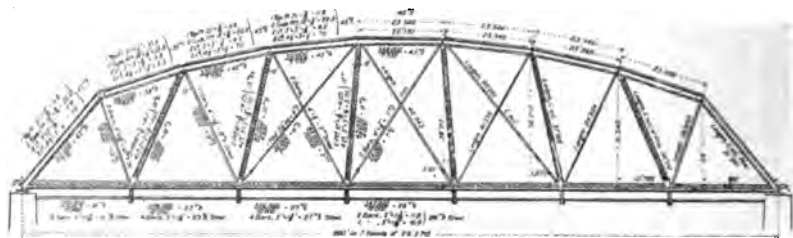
Pont sur le Marmaton River (Travée de 61^m,00). — D'après l'Engineering News.
